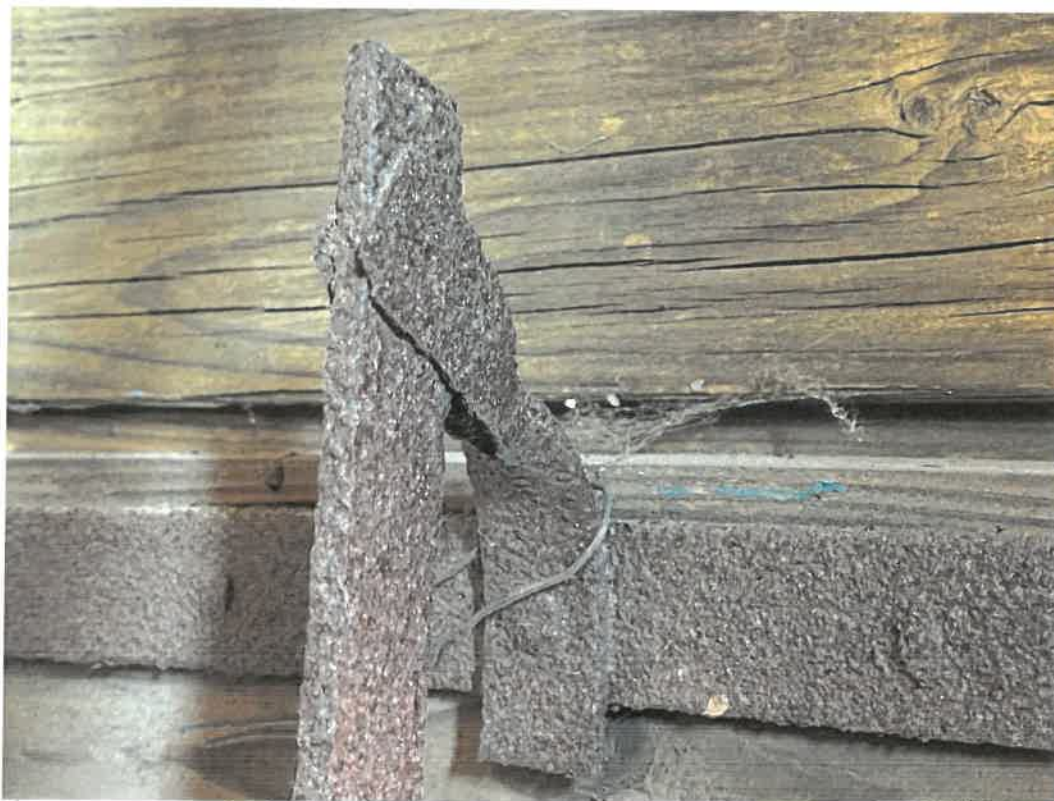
Połączenie elementów konstrukcji żaluzji
